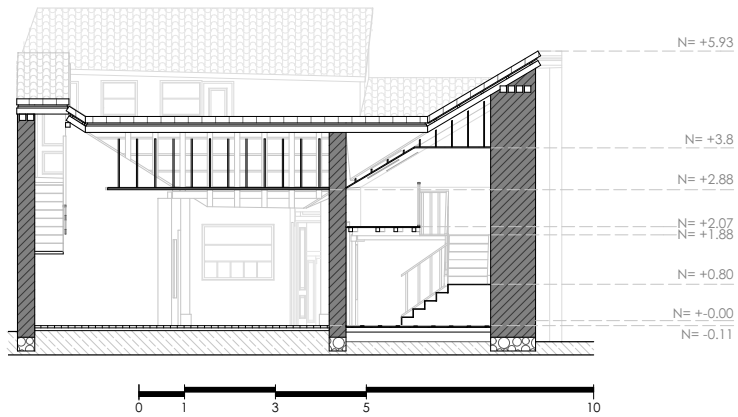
Sección transversal B - B | Caso de estudio 1, Vivienda Villacís.
